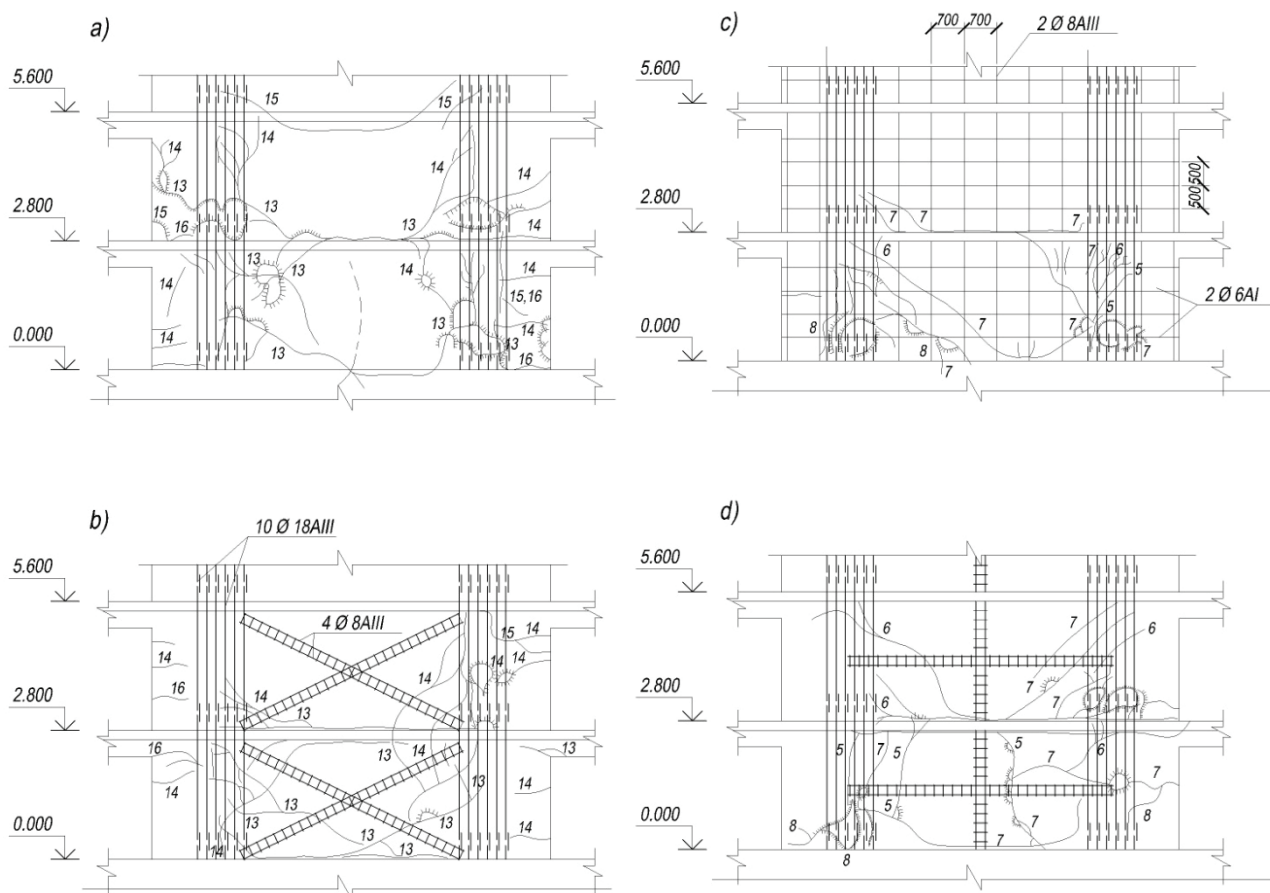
Трещинообразование и разрушение стен с различным полевым армированием фрагментов (вид изнутри фрагментов; цифрами обозначены этапы испытаний)
